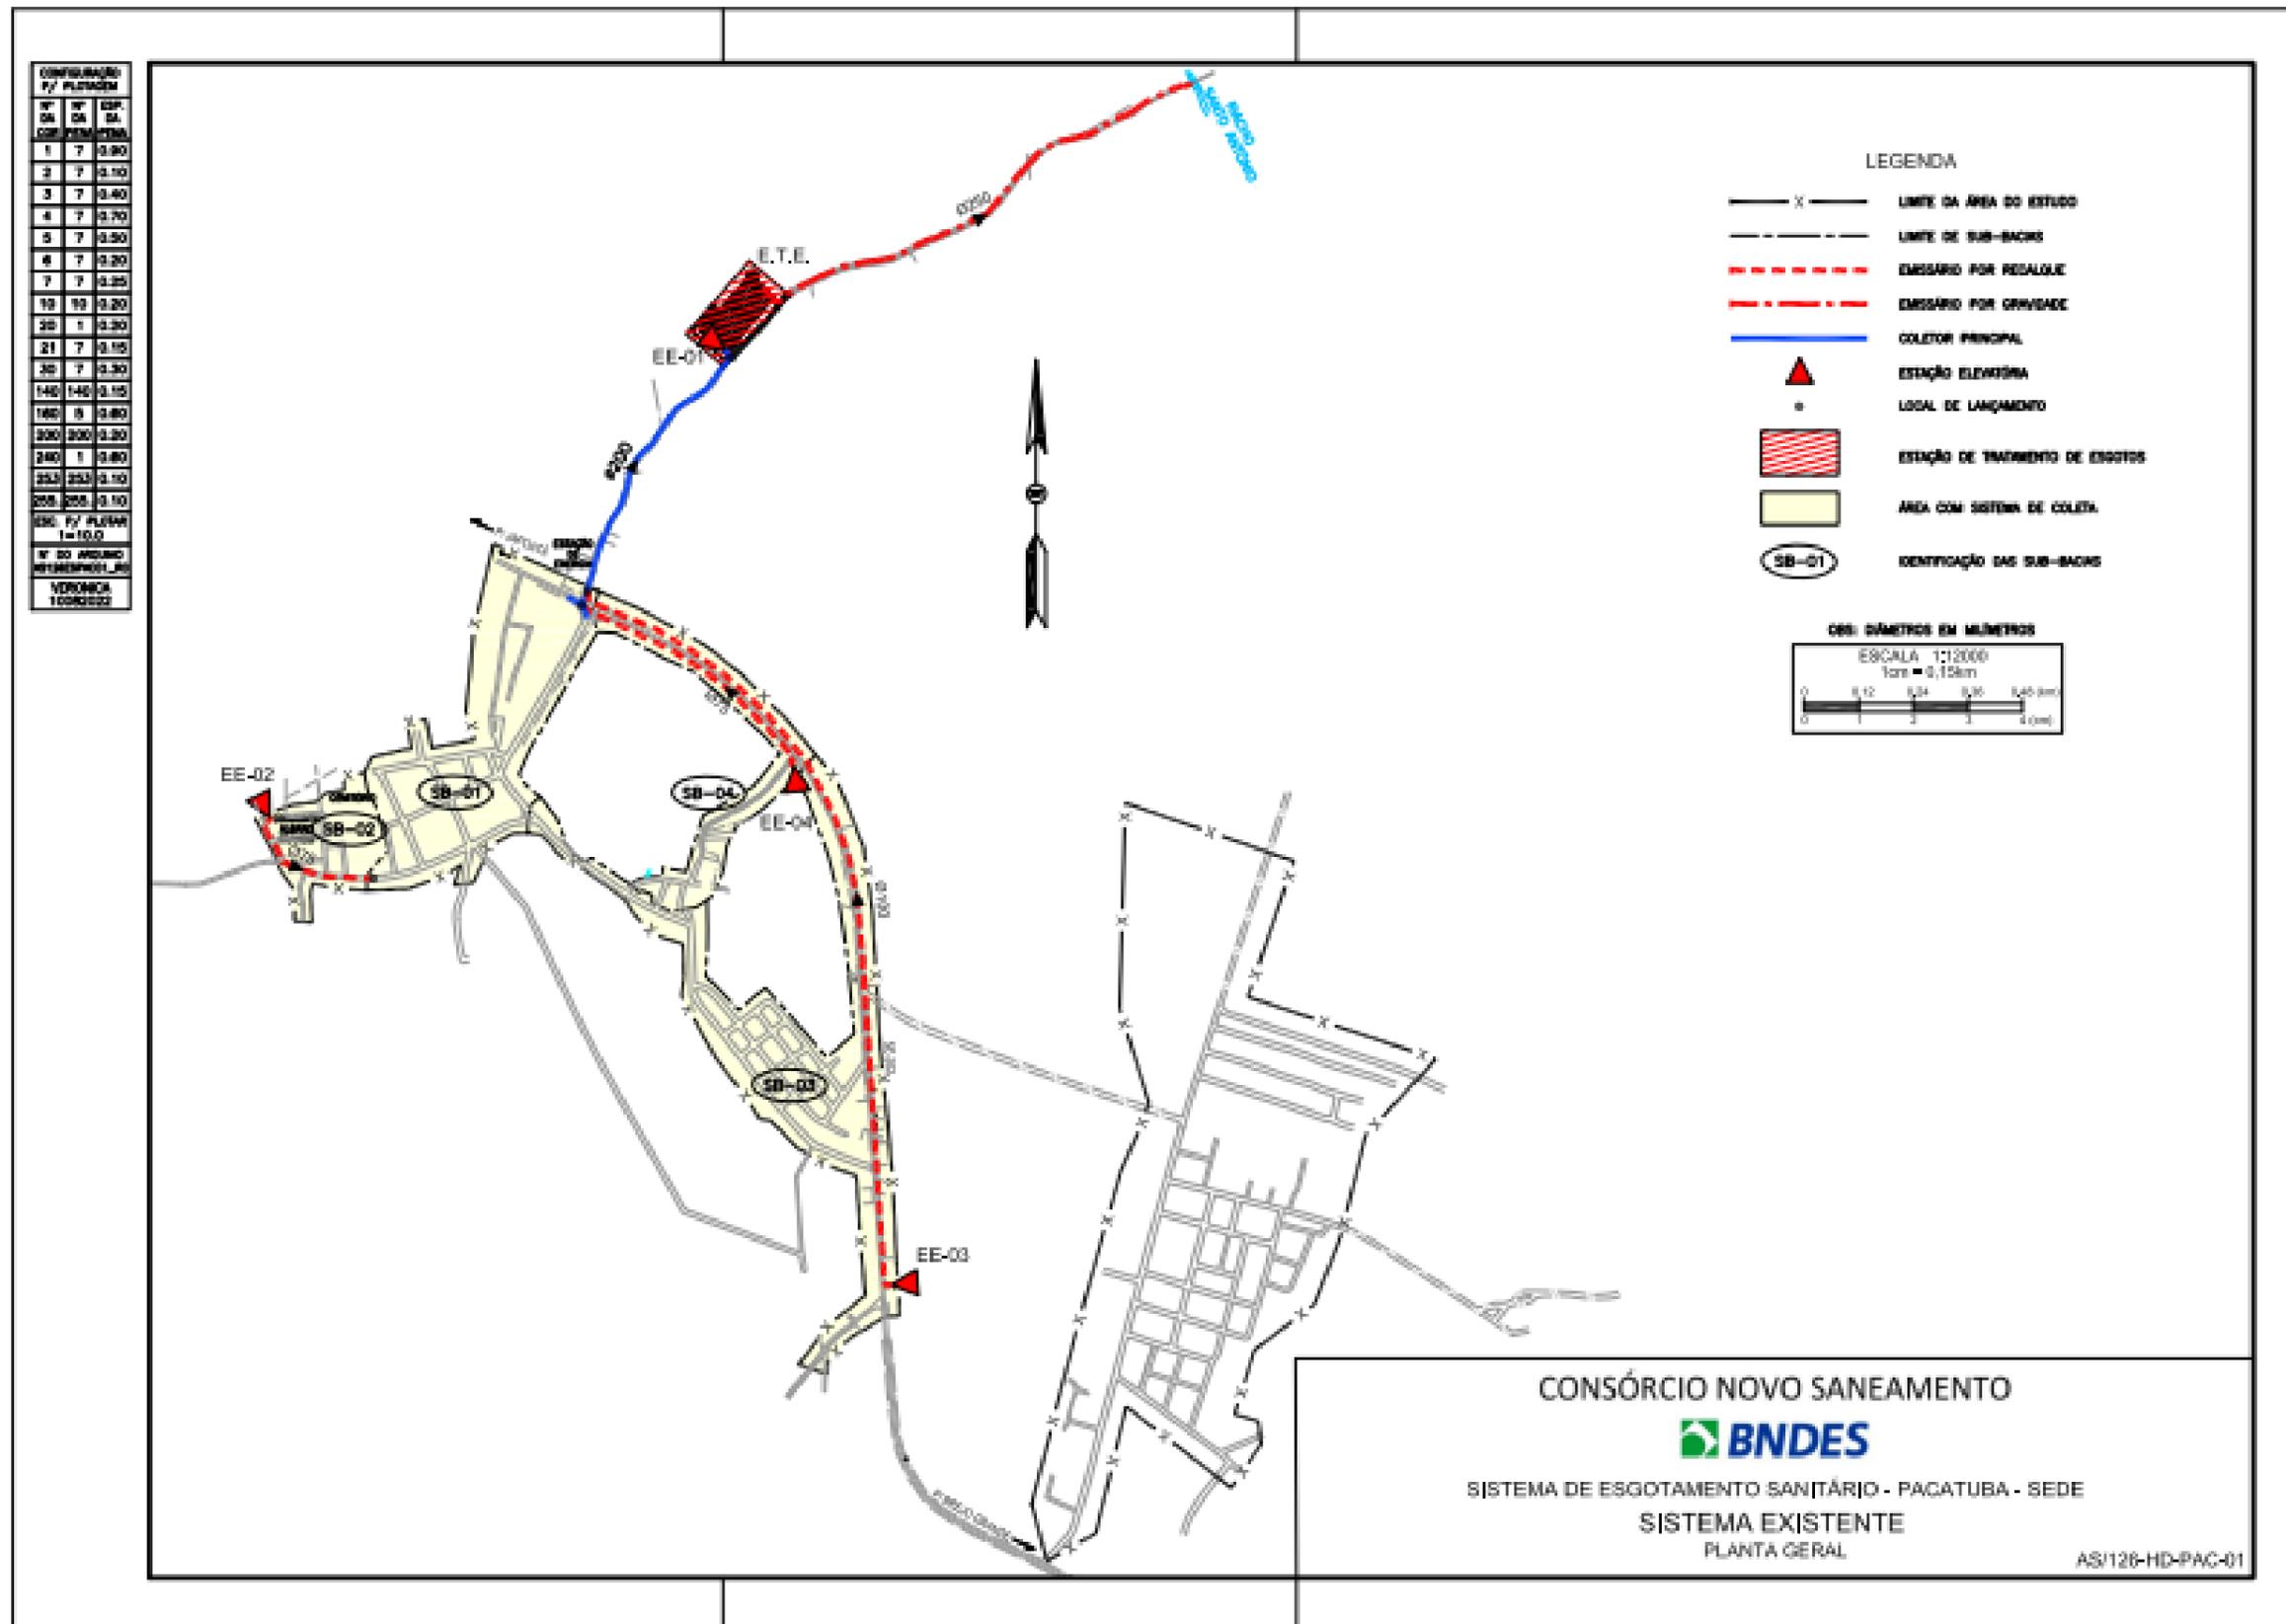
Planta do Sistema de Esgotamento Sanitário – PACATUBA
